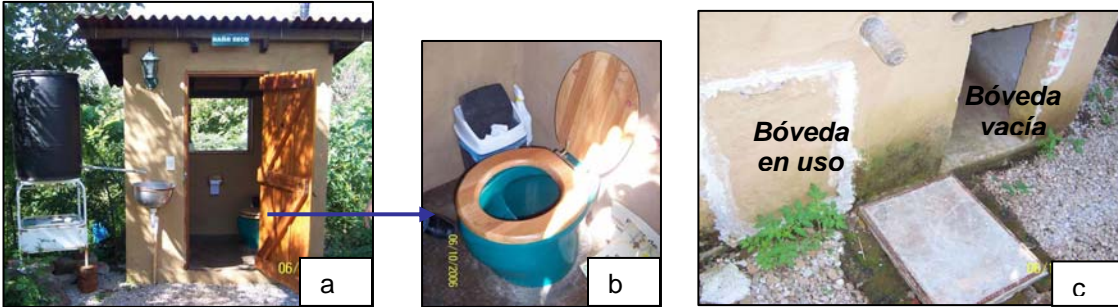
Sanitario separador seco ubicado en una estructura separada de la vivienda. (a) Estructura principal, (b) sanitario separador y (c) bóvedas de almacenaje.
